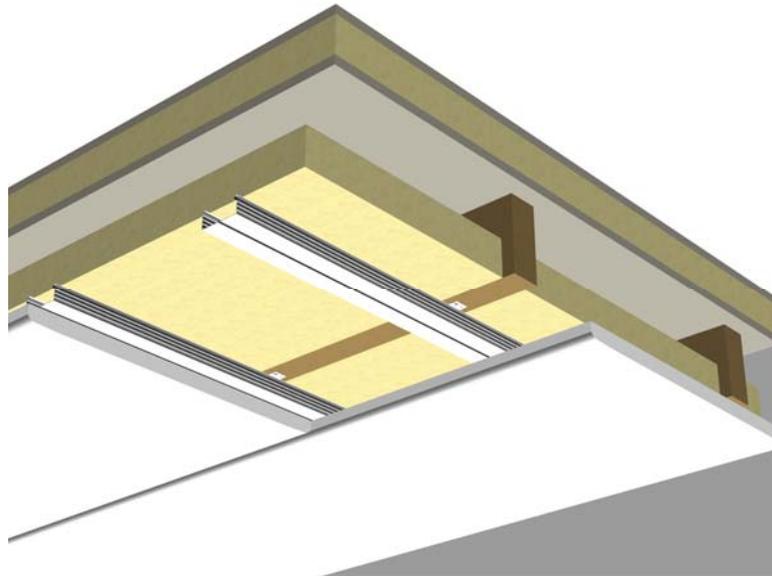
Exemplarischer Aufbau einer Holzbalkendecke
